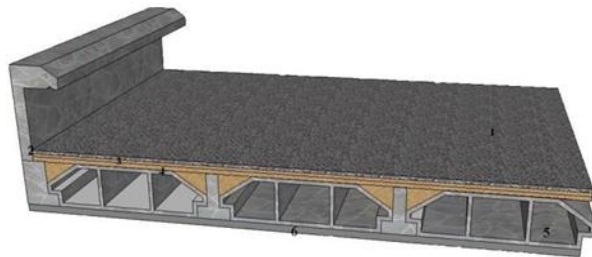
Coupe verticale du plancher terrasse à corps creux.
